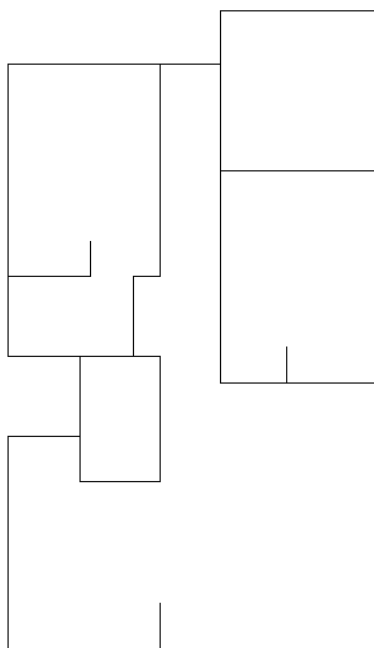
Planta de preparación de la vivienda para modelar en SAP2000.
